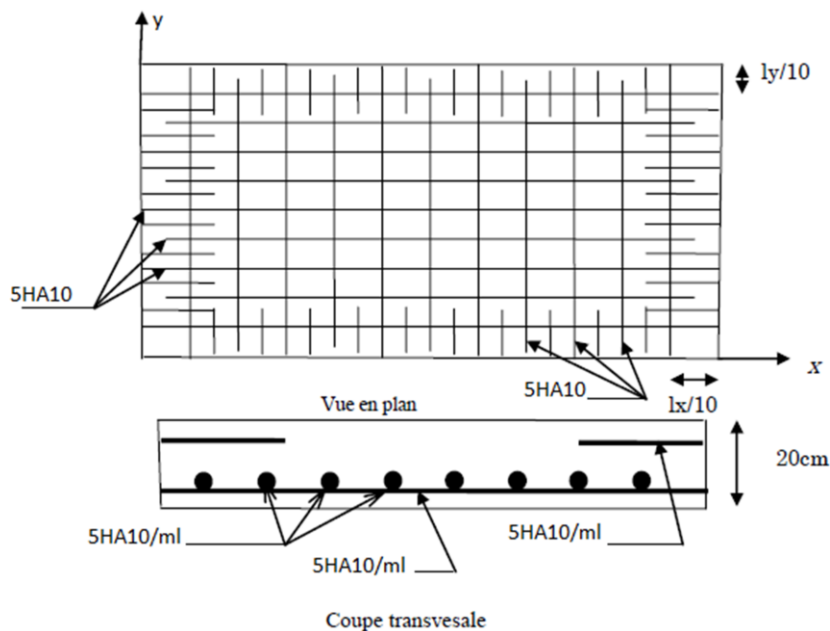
schéma de ferrailage de la dalle d'ascenseur
